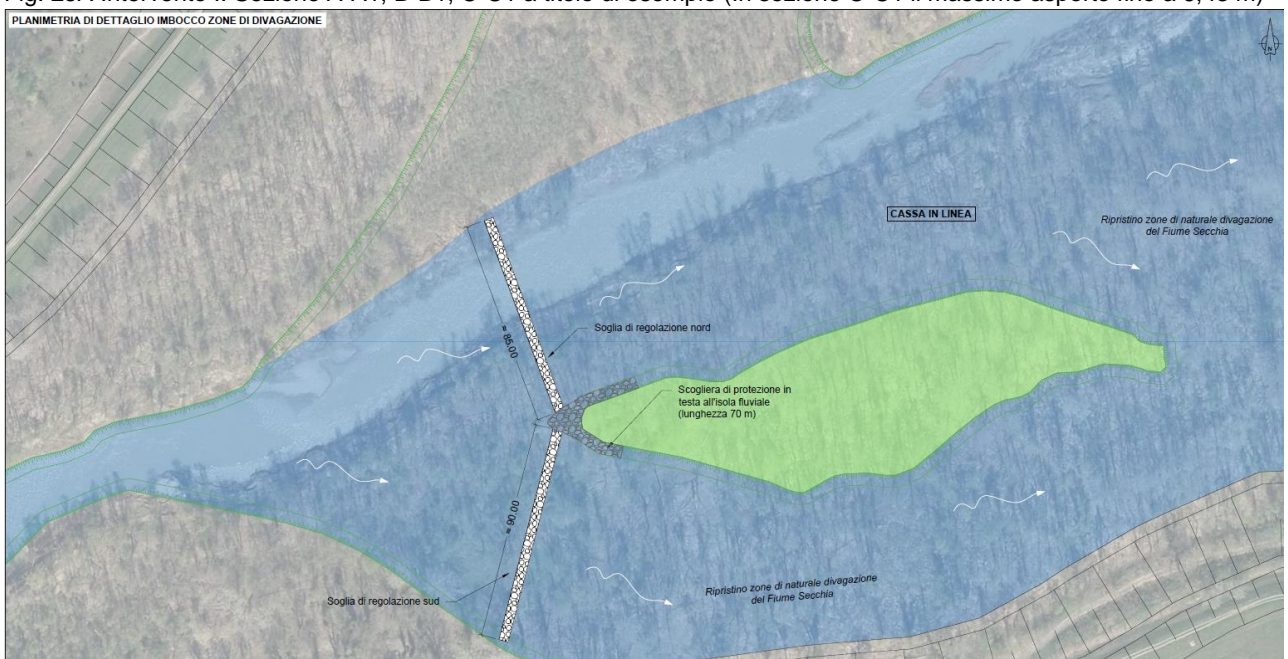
Intervento I: dettaglio imbocco laterale planimetria
